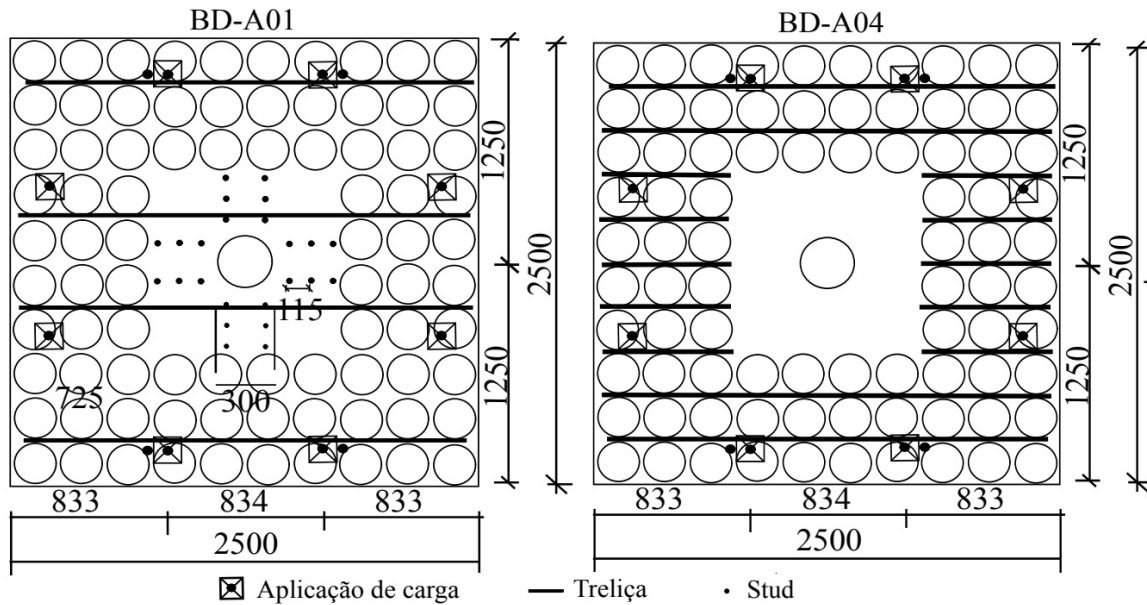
Lajes da quinta série de concretagem (dimensões em mm)
